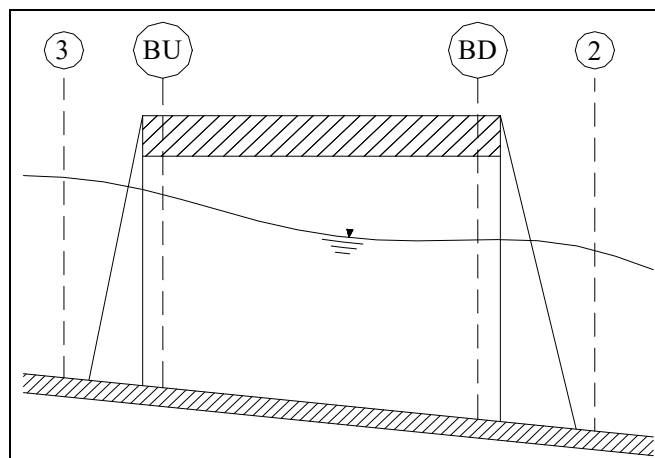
Sezione schematica di un attraversamento fluviale
